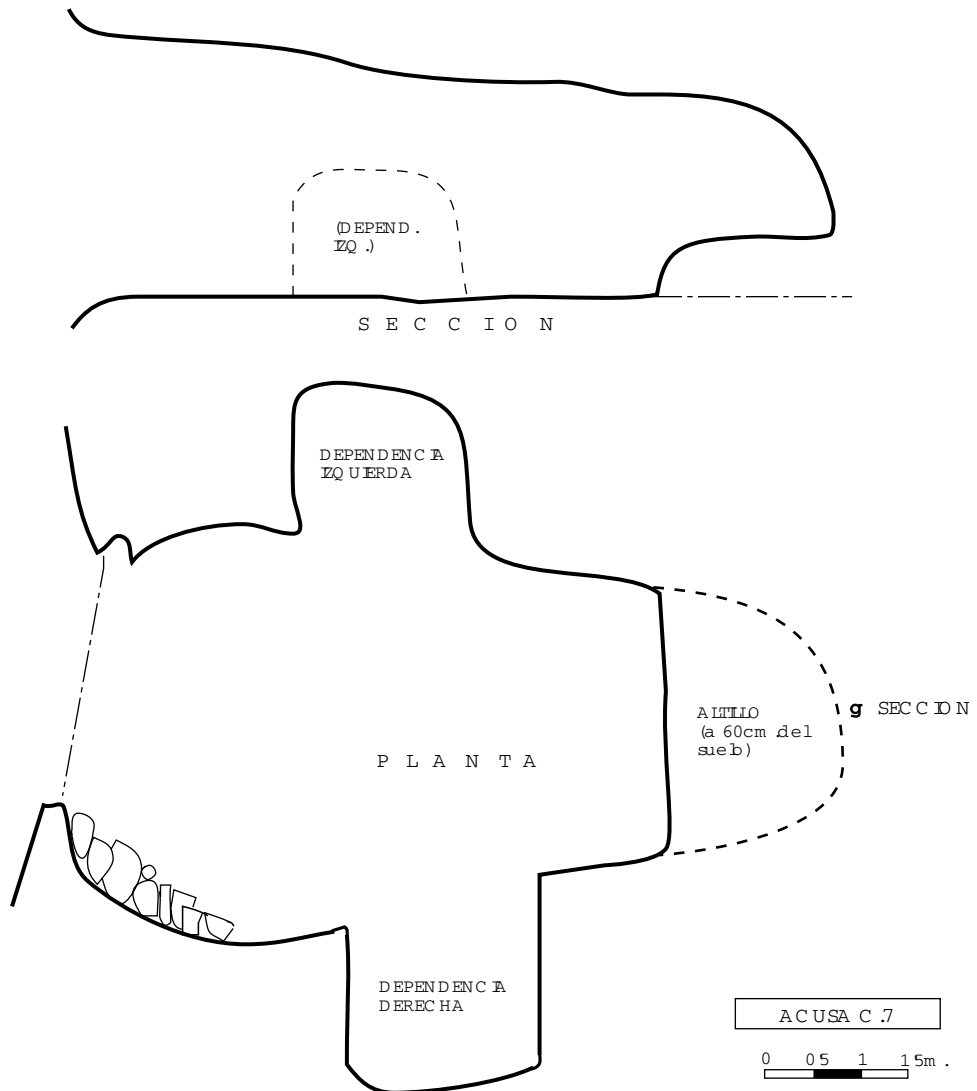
ACUSA C.7: PLANTA Y SECCION
